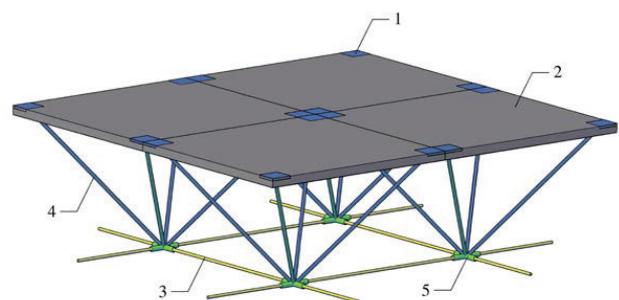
Фрагмент сталезалезобетонного структурно-вантового покрытия: 1 — закладные детали; 2 — армоцементная плита, армированная несколькими слоями арматурных сеток; 3 — ванта; 4 — раскос структурной решетки; 5 — узел крепления стержней структурной решетки и элементов нижнего пояса
